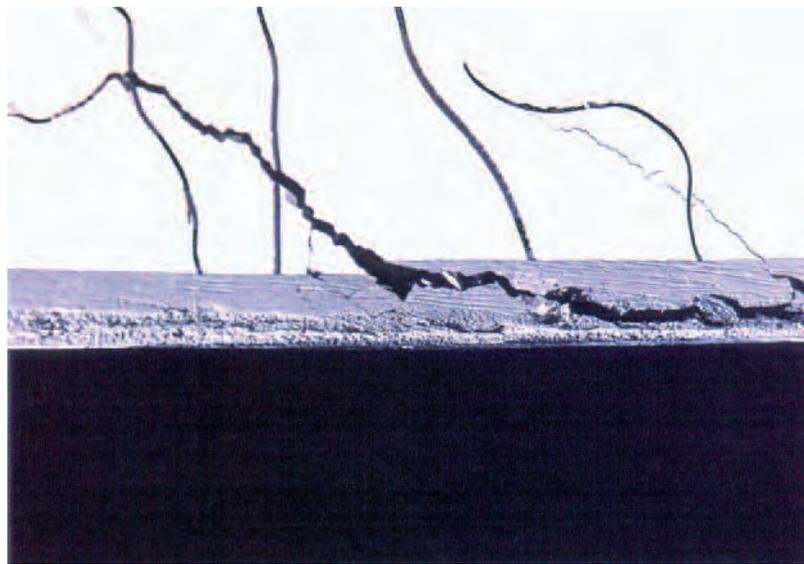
exemple de rupture par délamination (crédit photo SIKA)
